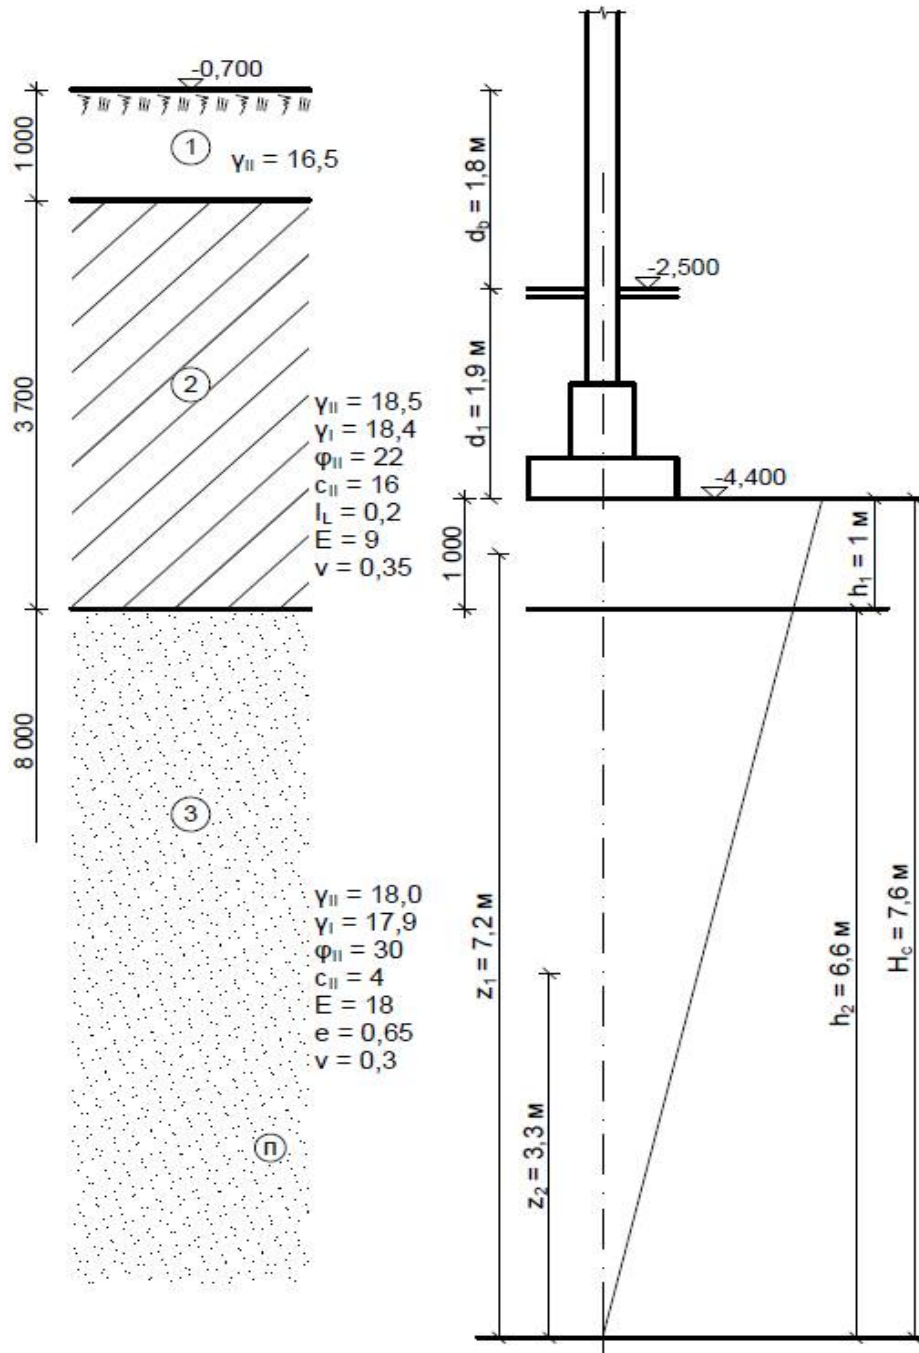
Розміщення фундаменту у ґрунті та розрахункова схема для розрахунку осідання методом еквівалентного шару
